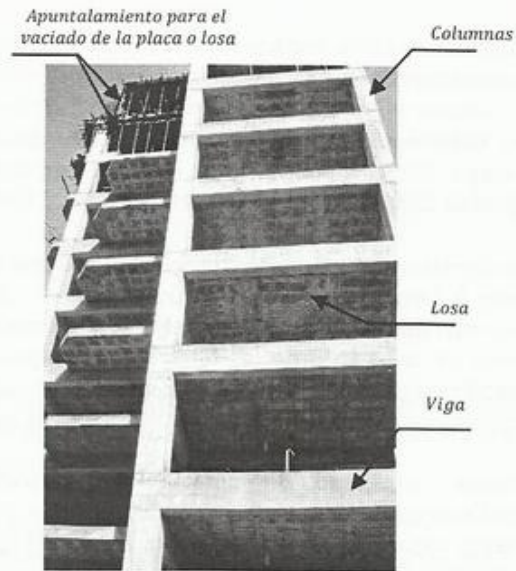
Proceso constructivo de un edificio aporticado de vigas y columnas
